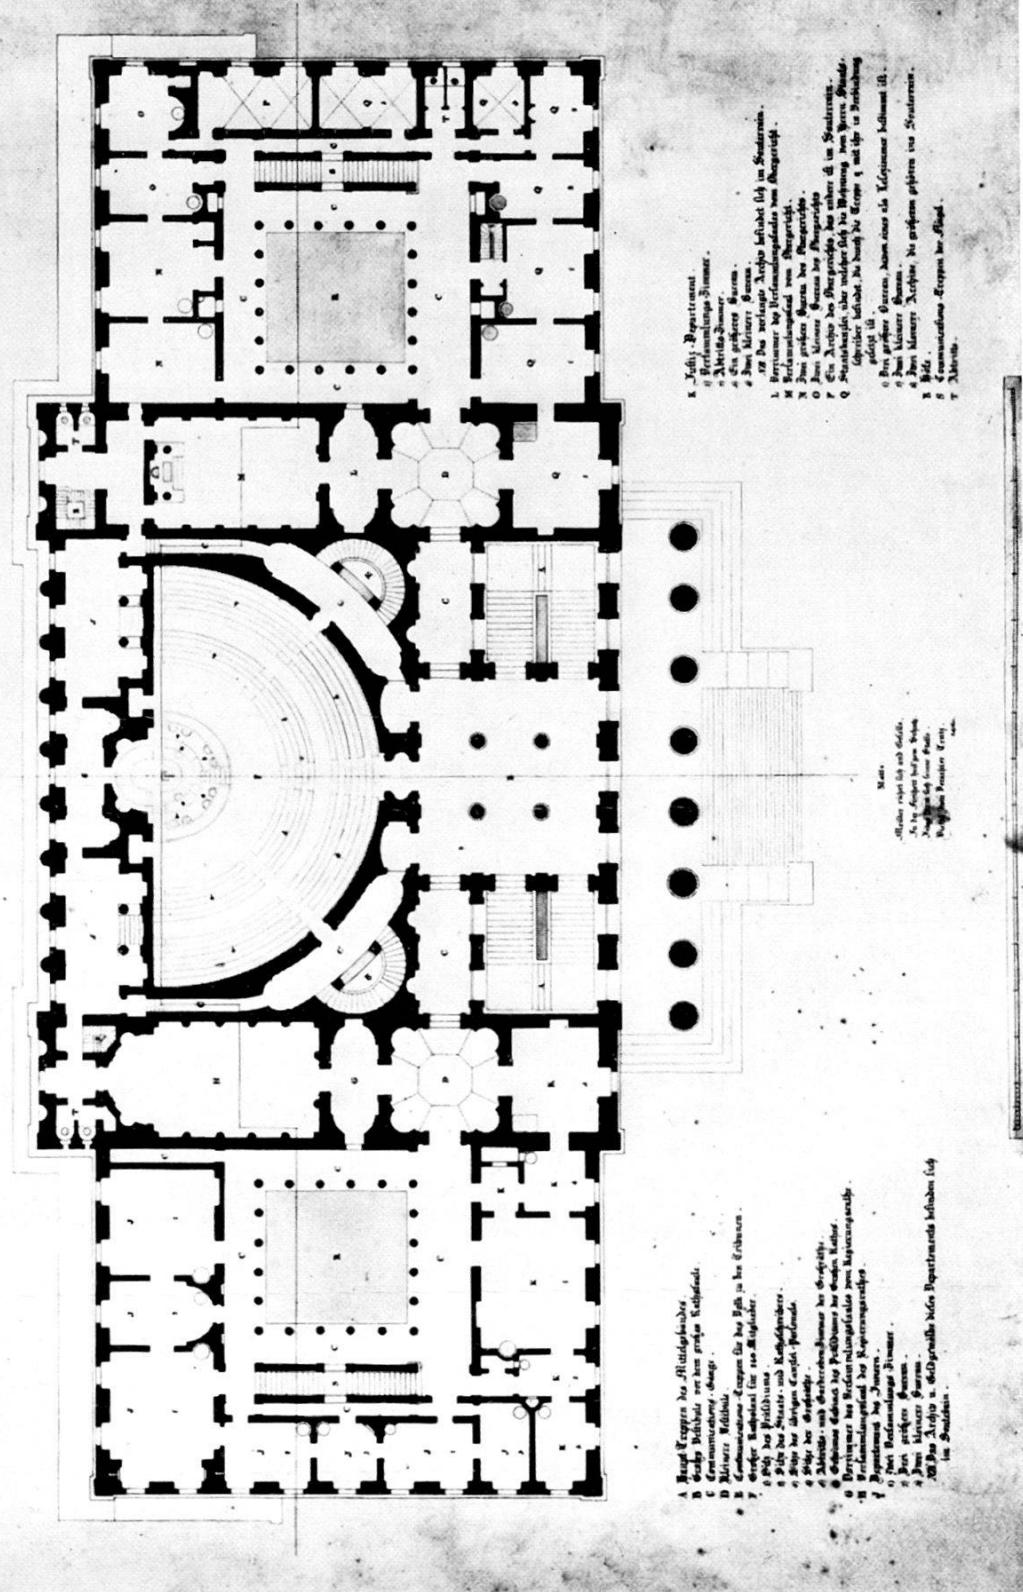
Berri, Rathaus Bern, Grundriss Hauptgeschoss. — Photo Denz-Clische, Bern.
